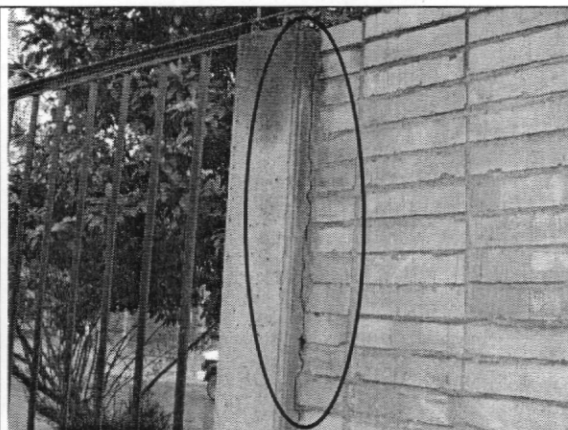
Fisura en la junta entre columna y mampostería
